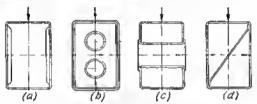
Vigas de paredes delgadas de sección rectangular con riostras trans-
